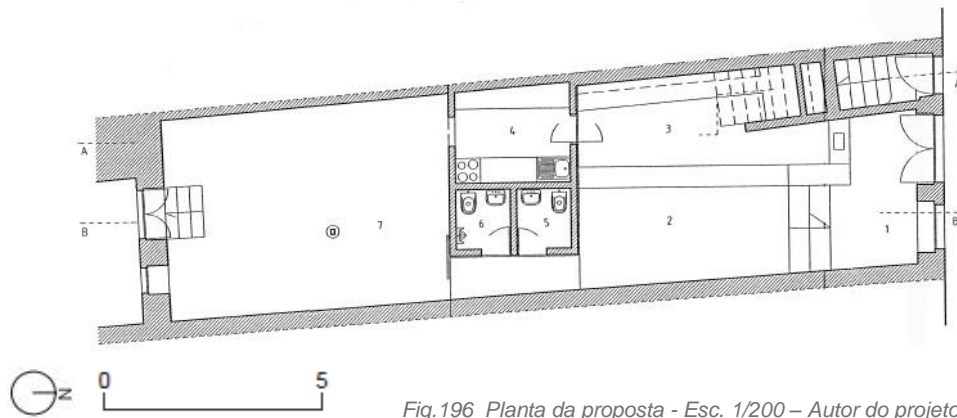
Planta da proposta - Esc. 1/200 – Autor do projeto
